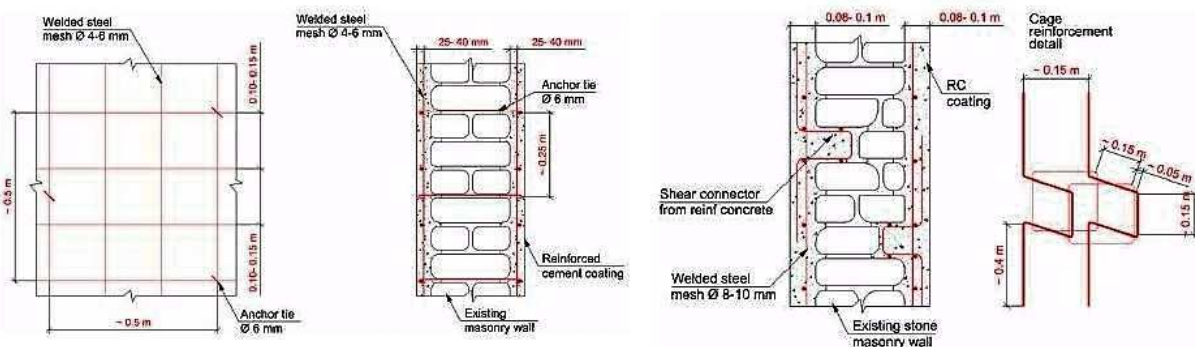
Encamisamento de paredes de alvenaria com betão armado.[20]
